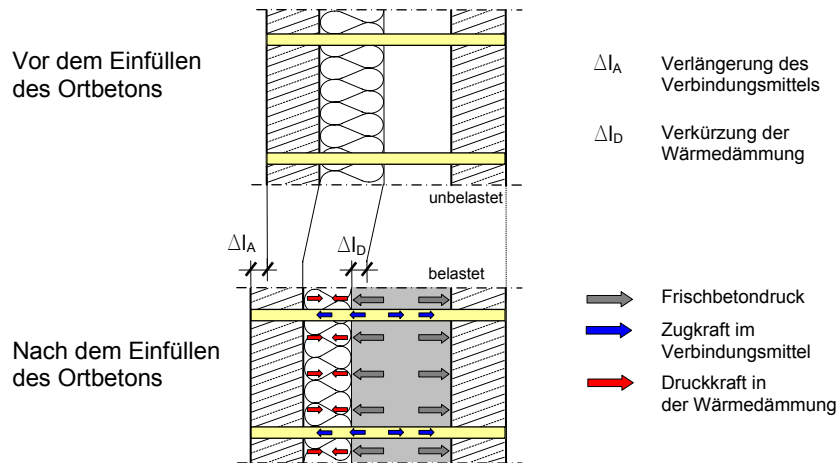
Beanspruchungen im Wandquerschnitt unter dem Lastfall Frischbetondruck
